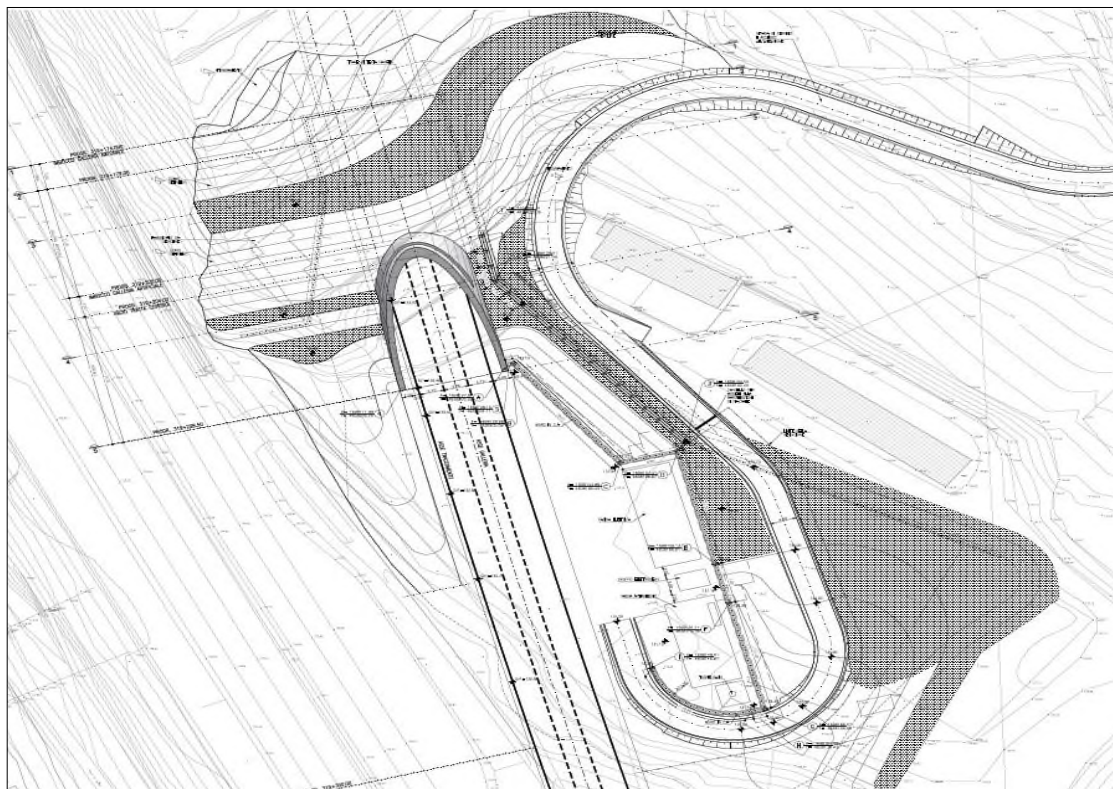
Sistemazione finale dell'imbocco Sud Galleria Bruschetto (stralcio planimetrico da APE2290)
